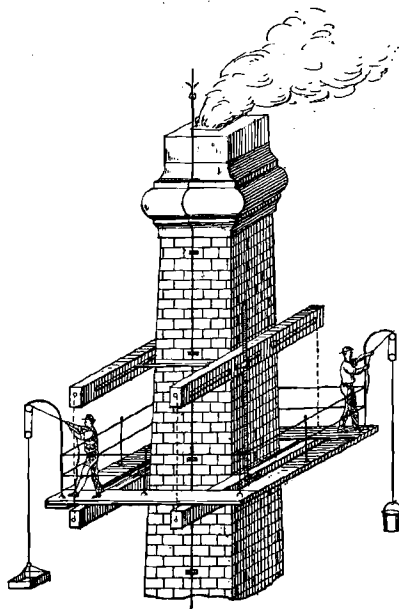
Echafaudage pour la construction et la réparation des cheminées d'usine.
